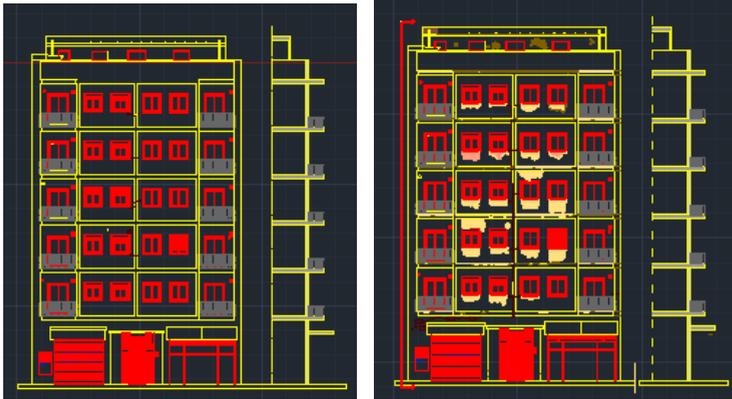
Levantamiento de planos y mapeado con la herramienta informática AutoCad 2013
